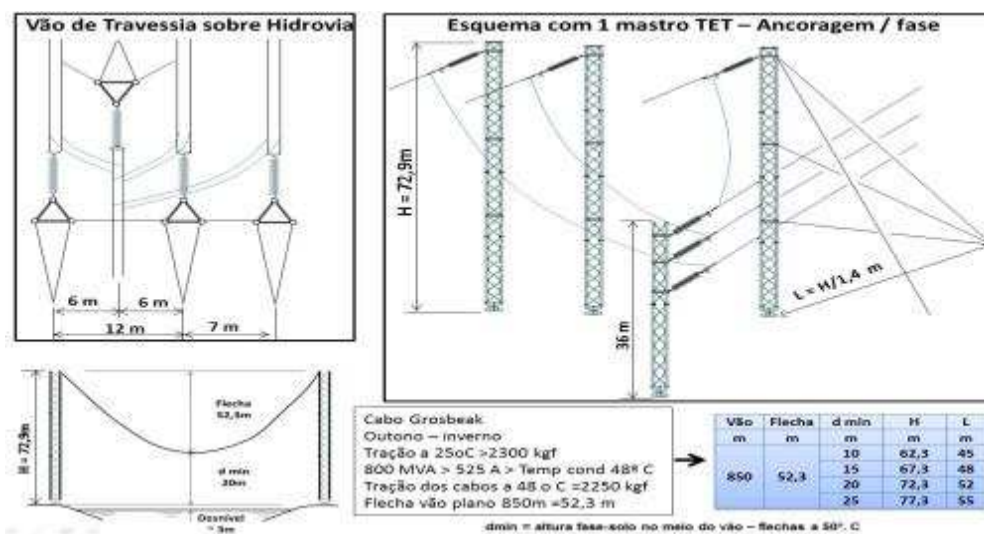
Detalhes da configuração escolhida para o vão de travessia
